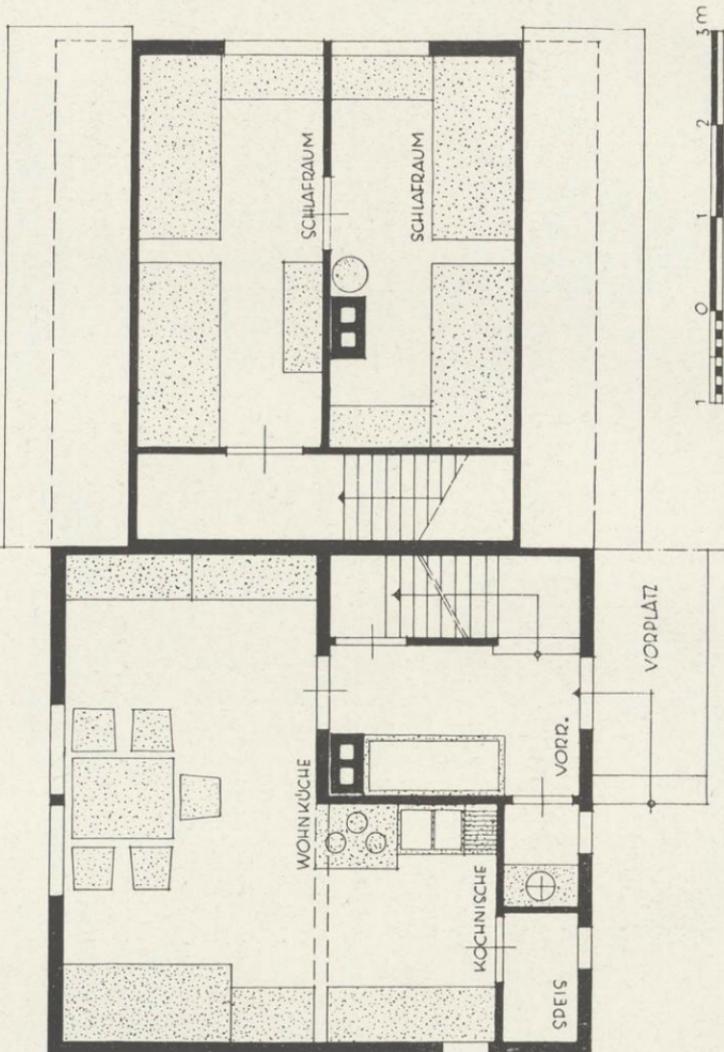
Raumausteilung (Grundriß) des Siedlungshauses St. Peter-Linz Type B
